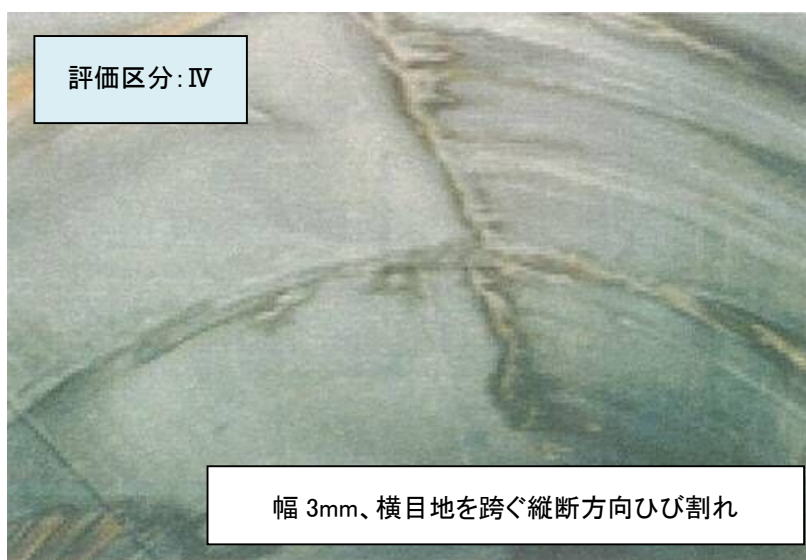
損傷例(覆工:ひび割れ:進行性あり)
